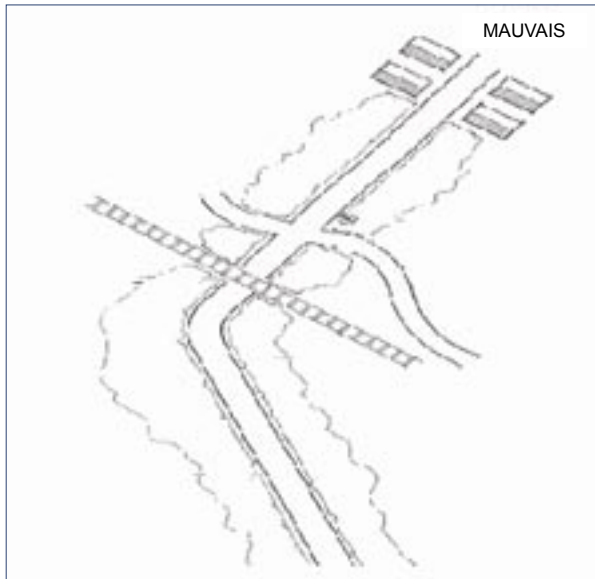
Cumul d'un croisement d'une voie ferrée non visible, d'une intersection routière et d'une entrée de ville après un virage et une section droite monotone en amont [15]
